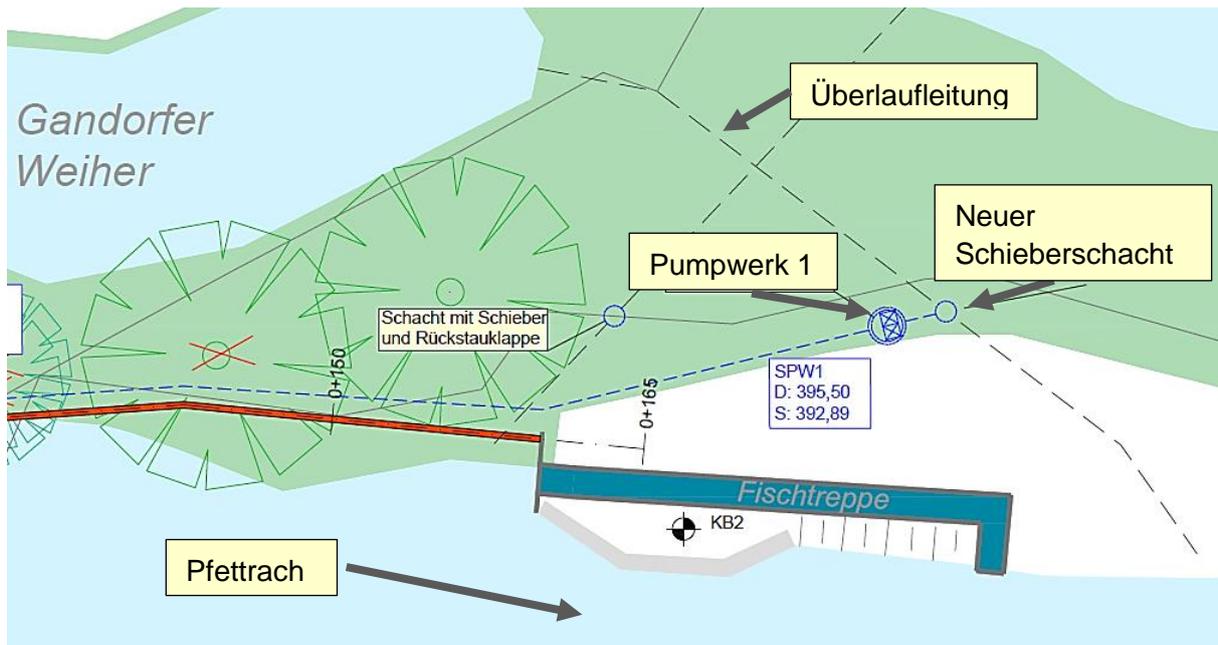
Lage des Schachtpumpwerks 1 (Ausschnitt aus Lageplan E 20)
